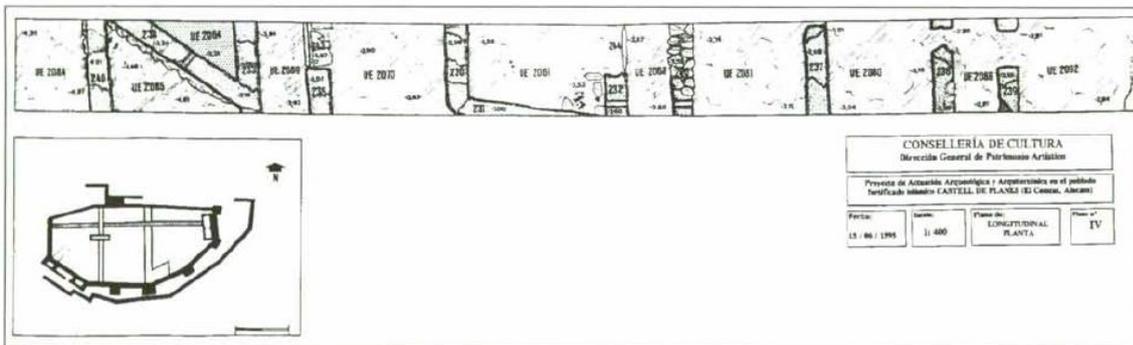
Planta de las estructuras exhumadas en el sector Este.
